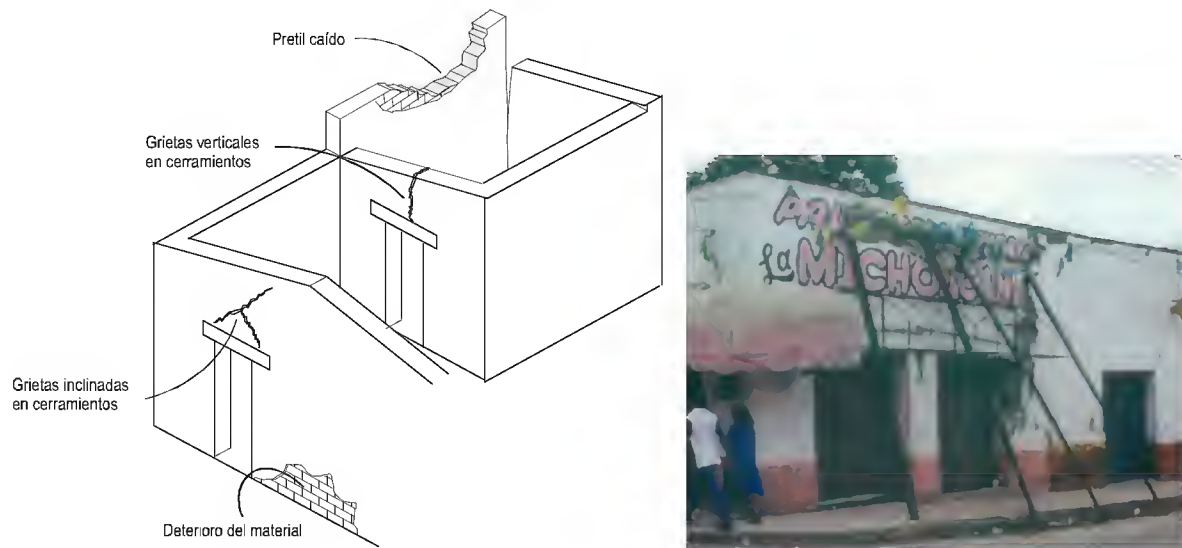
Grietas en cerramientos y daño en pretil
